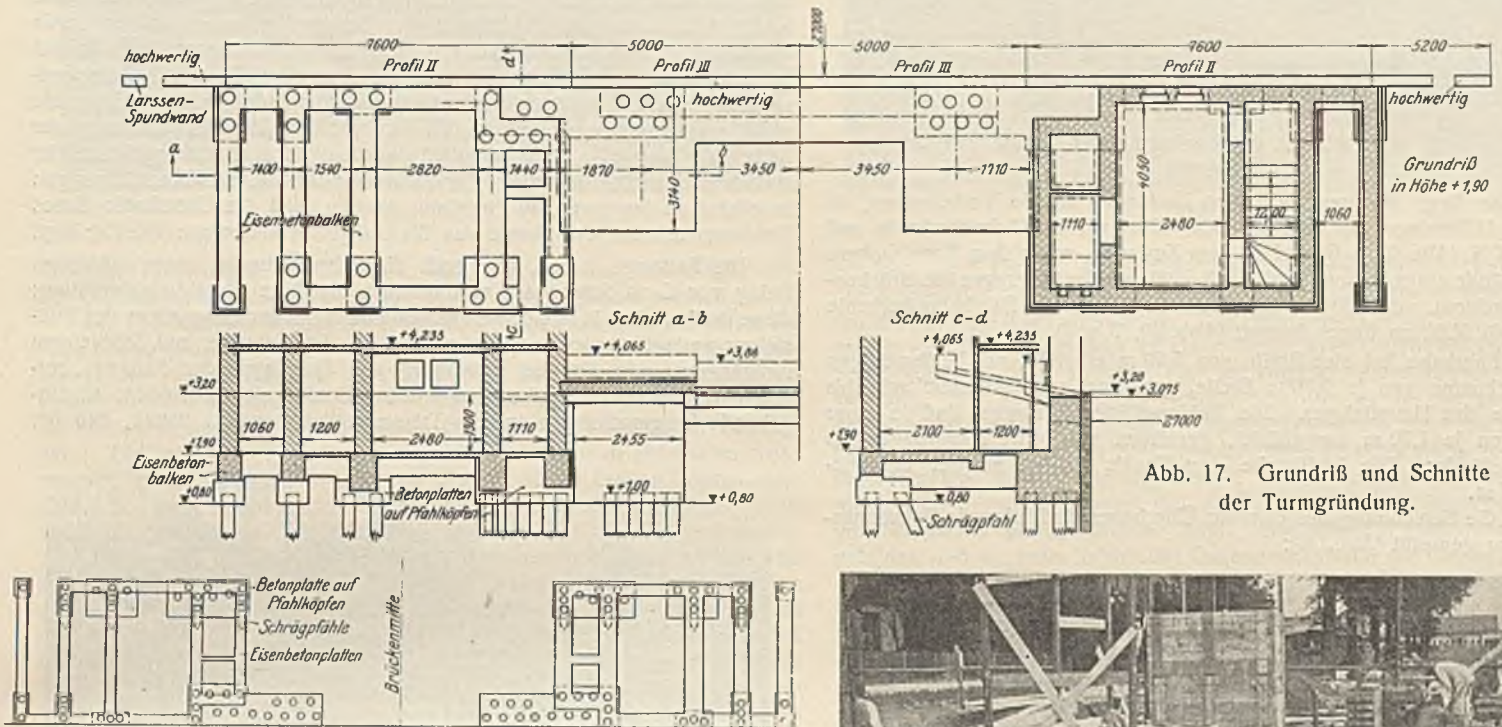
Grundriß und Schnitte der Turmgrundlage.
